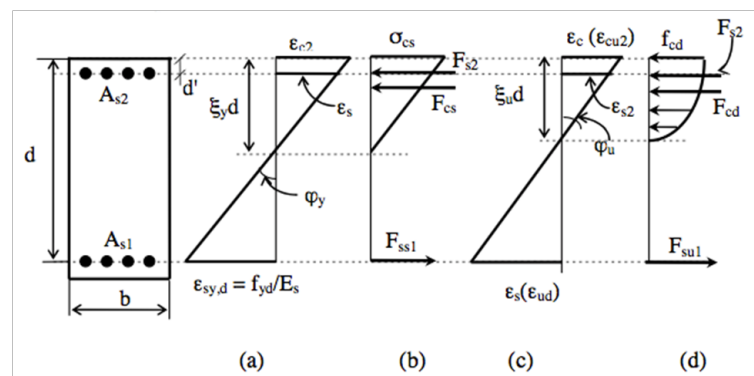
Compression d'une section fléchie d'une poutre
